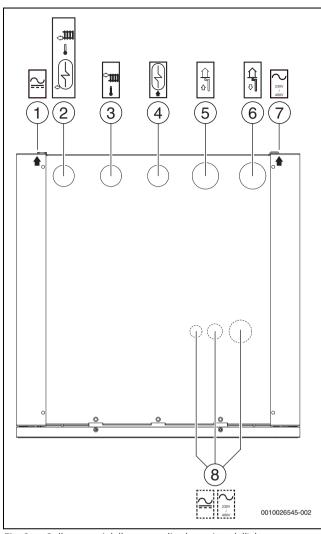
Collegamenti della pompa di calore, vista dall'alto
